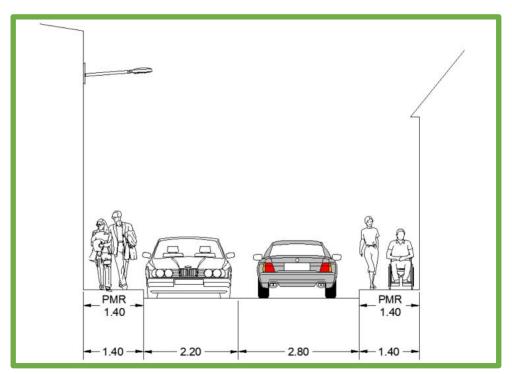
Lanterne sur façade (trottoir $\leq 1,40 \text{ m}$)
